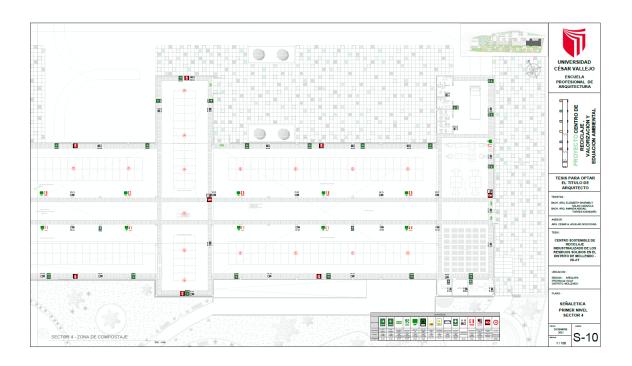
Plano de Señalética, Sector 4 – Primer Nivel FUENTE: Elaboración Propia
